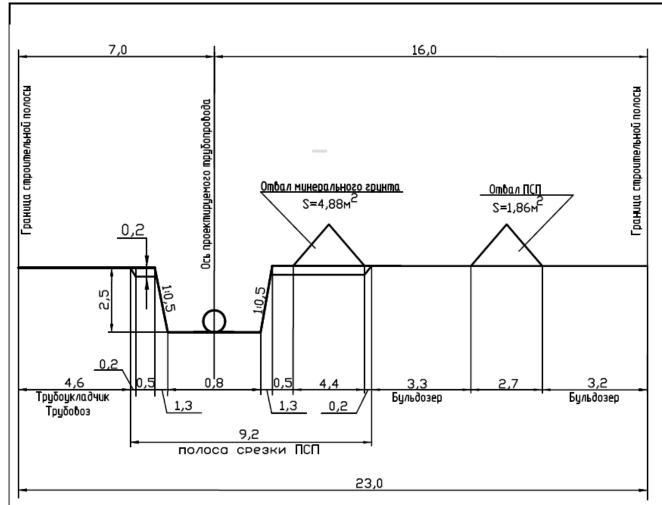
Схема строительной полосы на период строительства трубопровода
